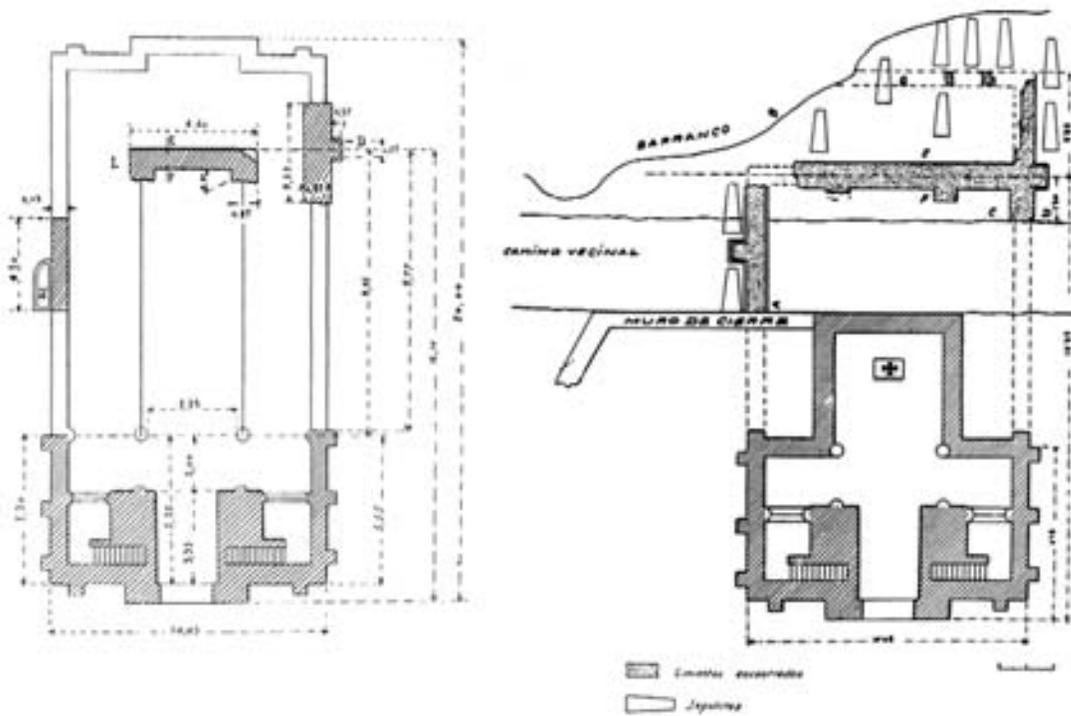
San Miguel de Liño. Planta general de las excavaciones realizadas por Aurelio de Llano en 1917
